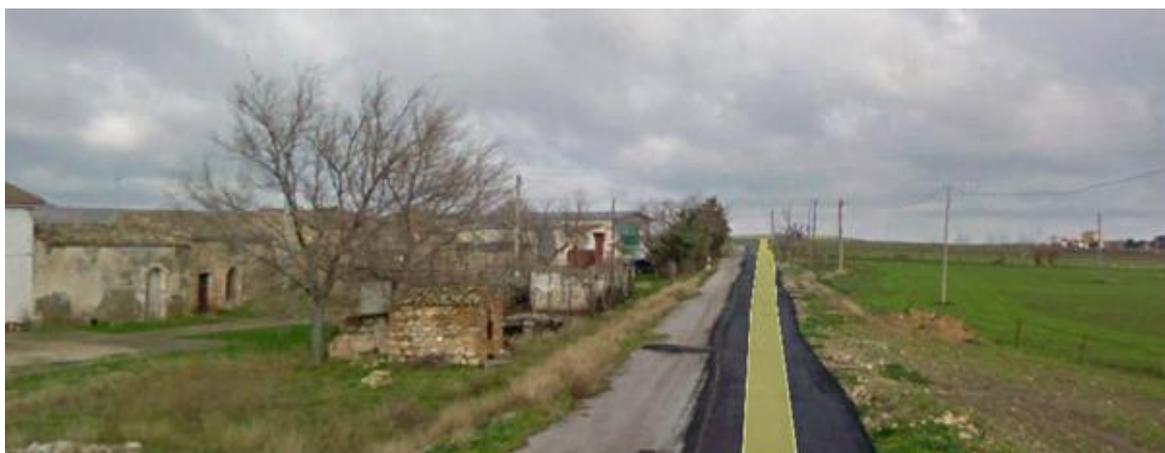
Attraversamento cavidotto esterno in area di rispetto "Masseria D'Amendola" – viabilità locale
